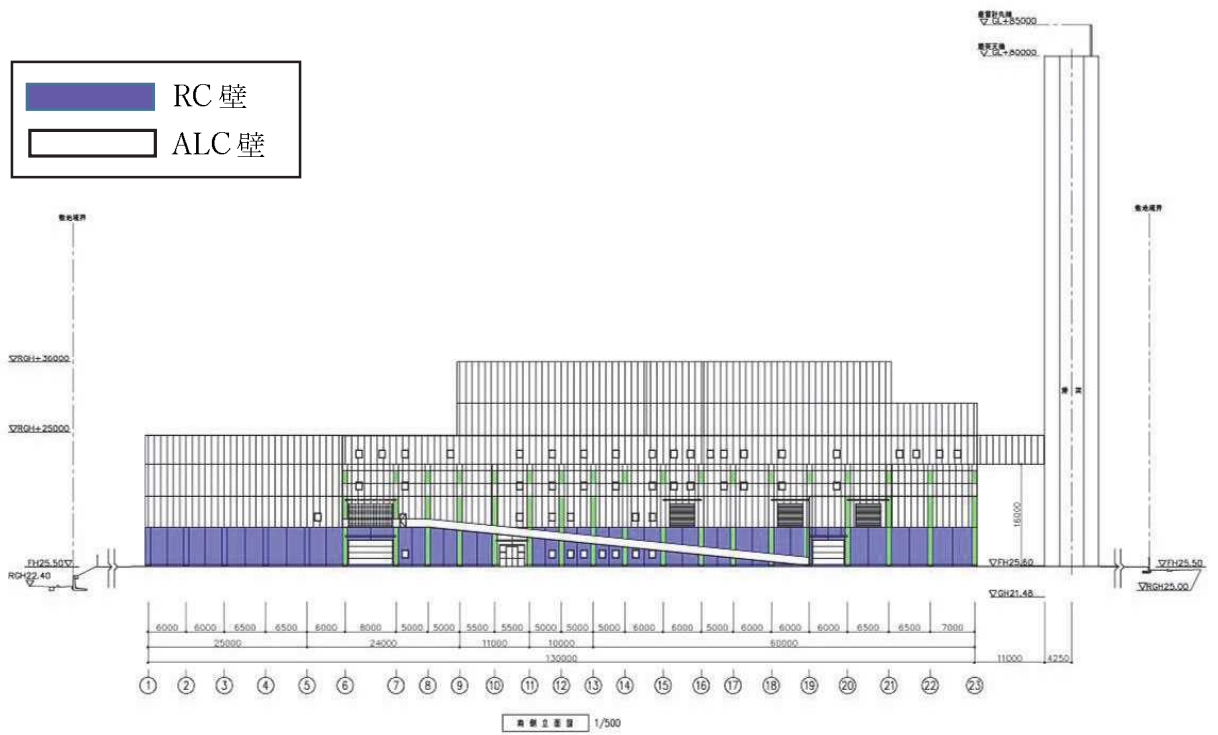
(2) 外壁の配置 (南側立面図)
